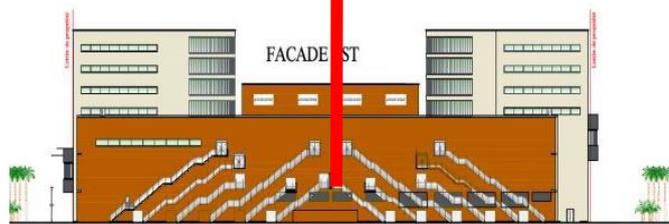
Façade EST du centre commercial de Bab Ezzouar.
